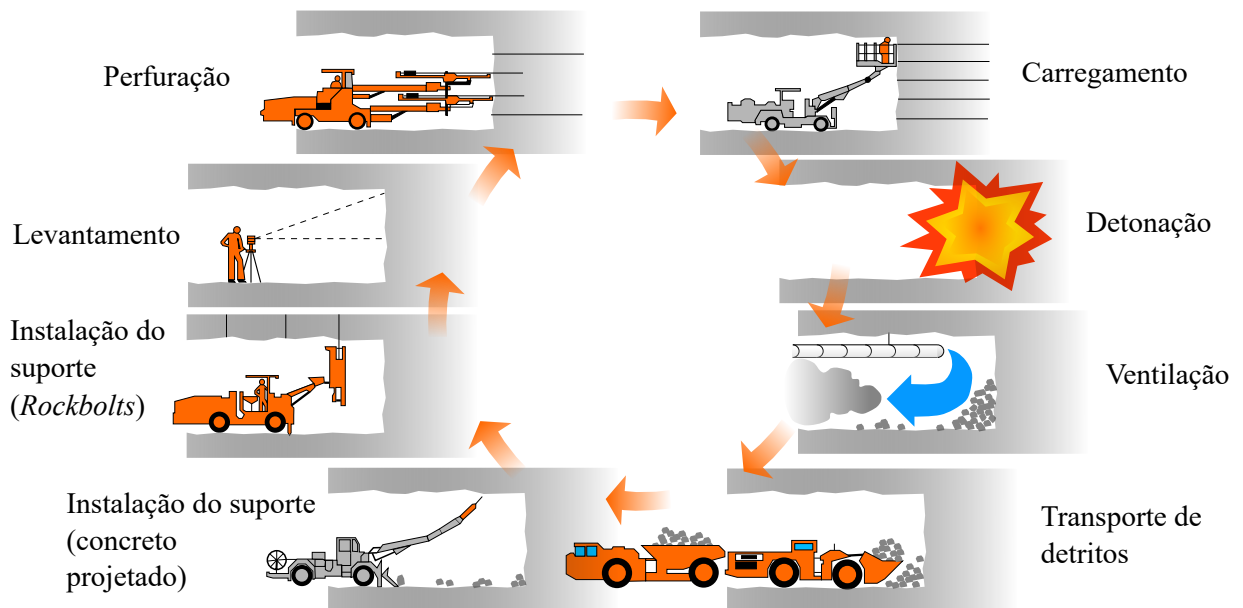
Sequência executiva do método de construção por perfuração e detonação (adaptado de Heiniö (1999))
